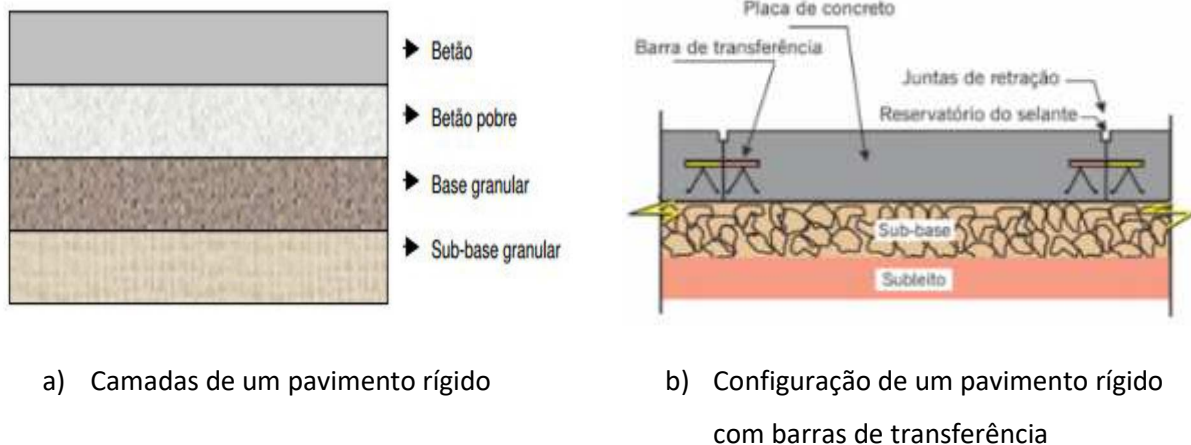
Diferentes camadas de um pavimento rígido (BIANCHI, 2008)
